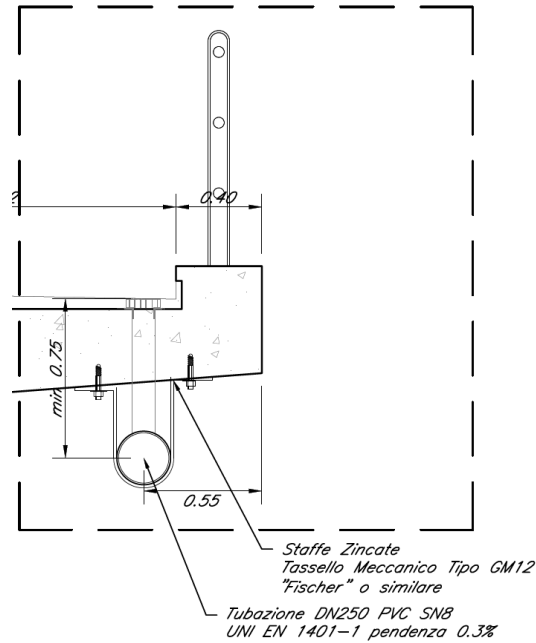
Viadotto – Sezione tipo Corrente PVC DN250
